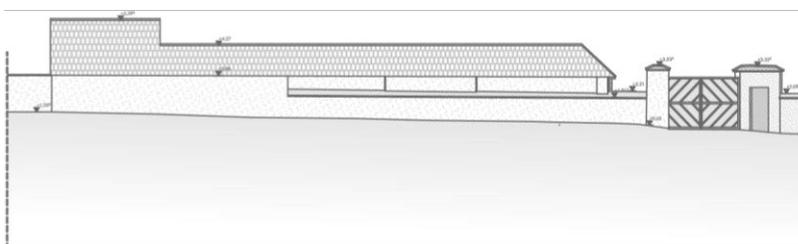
Bestandsplan Ansicht Ost Kegelbahn- Übersichtsplan
